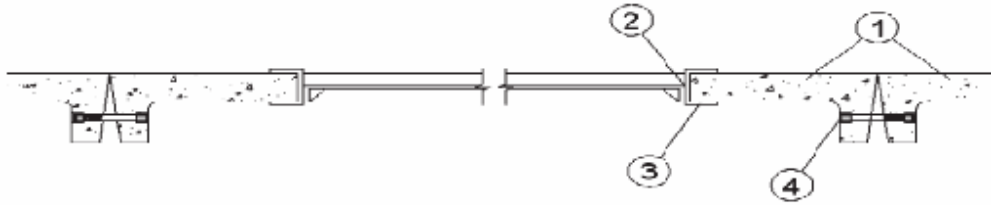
Acople con paneles ligeros. Detalles. 1-Panel prefabricado de hormigón, 2-Soldadura puntual, 3-Marco de ventana Estándar, 4-Conectores con tornillos.
